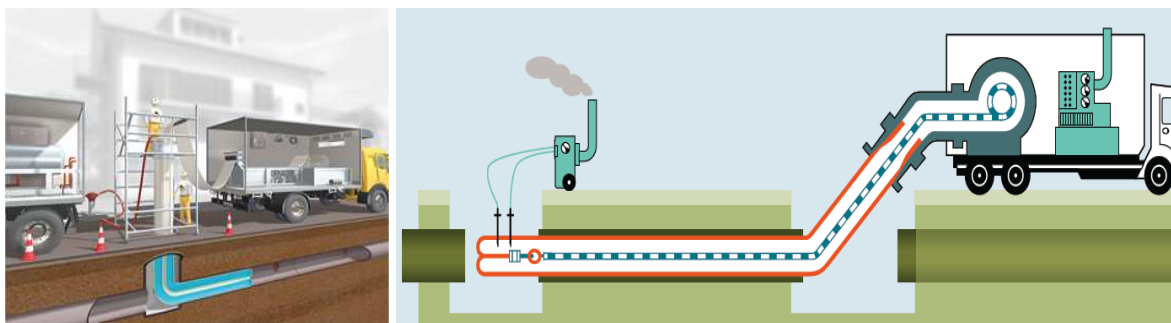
Inversion mit Wassersäule (links), Inversion mit Drucktrommel (rechts) [105]
